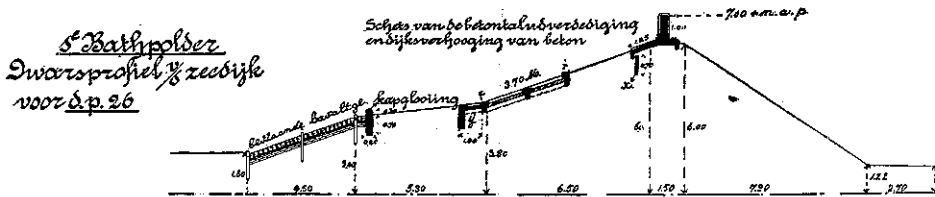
Dijkverhoging van gewapend beton (met ontgrondingsplaat) De betonpantsering van het buitentalud sluit niet aan den betonmuur aan
